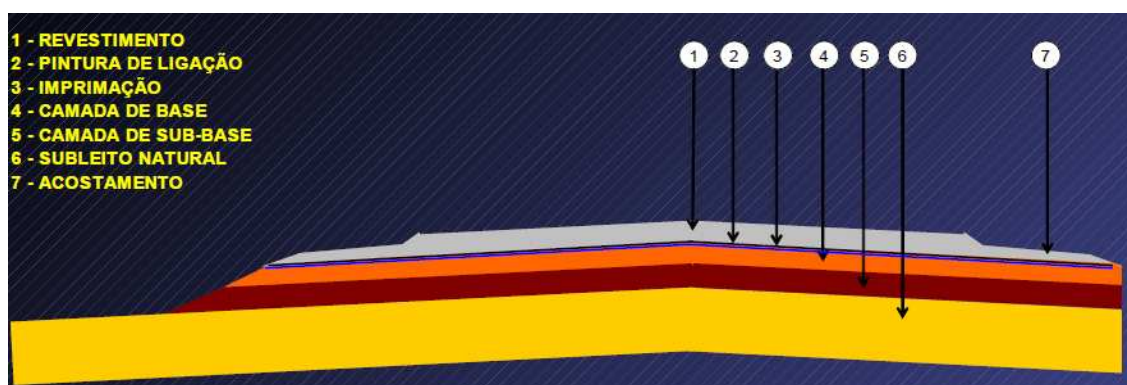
Seção transversal típica de um pavimento flexível.
